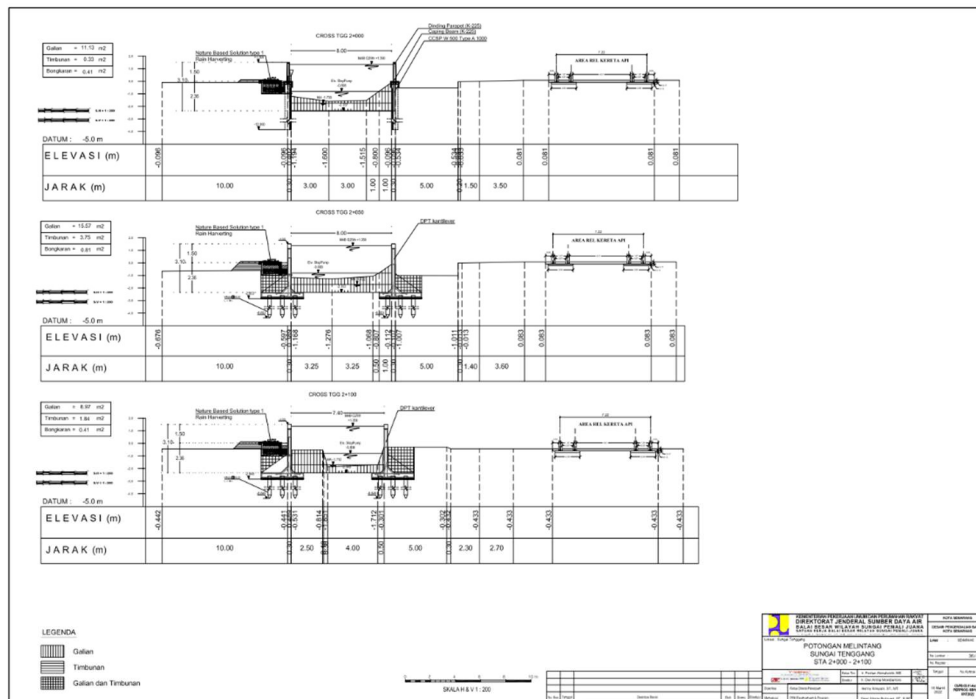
Layout Desain Ruas Sungai Tenggang Utama
